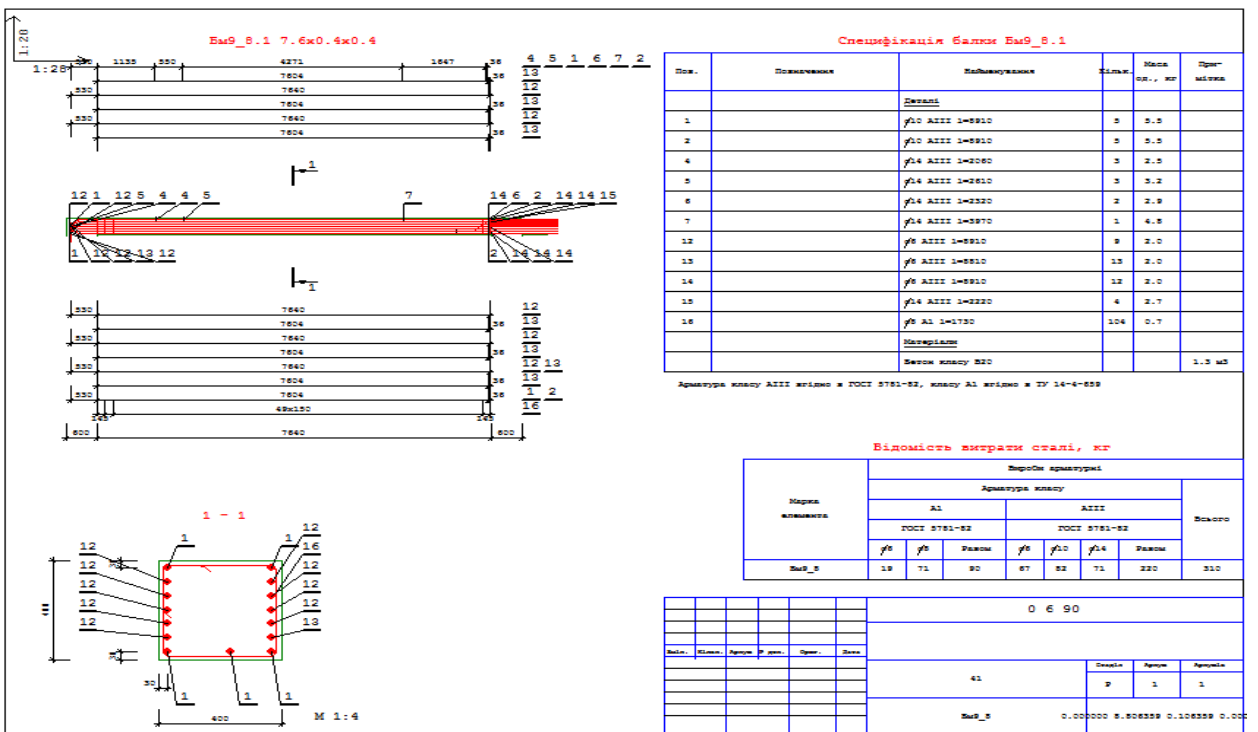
Варіант будинку з балочно - плитним перекриттям. Балка Б9-8. Креслення робочого проекту
